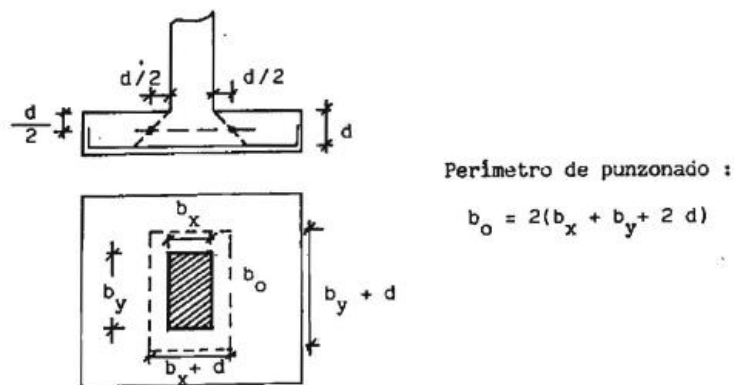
Perímetro crítico por punzonado en placas o zapatas
